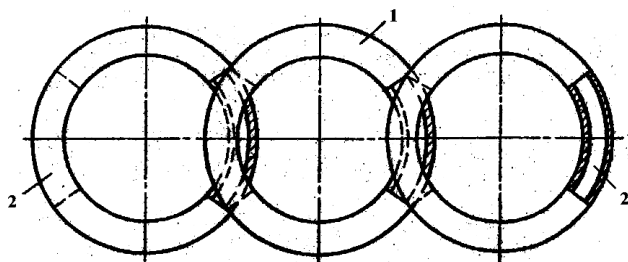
Стена временного сооружения из автомобильных покрышек на грунтовом основании.
